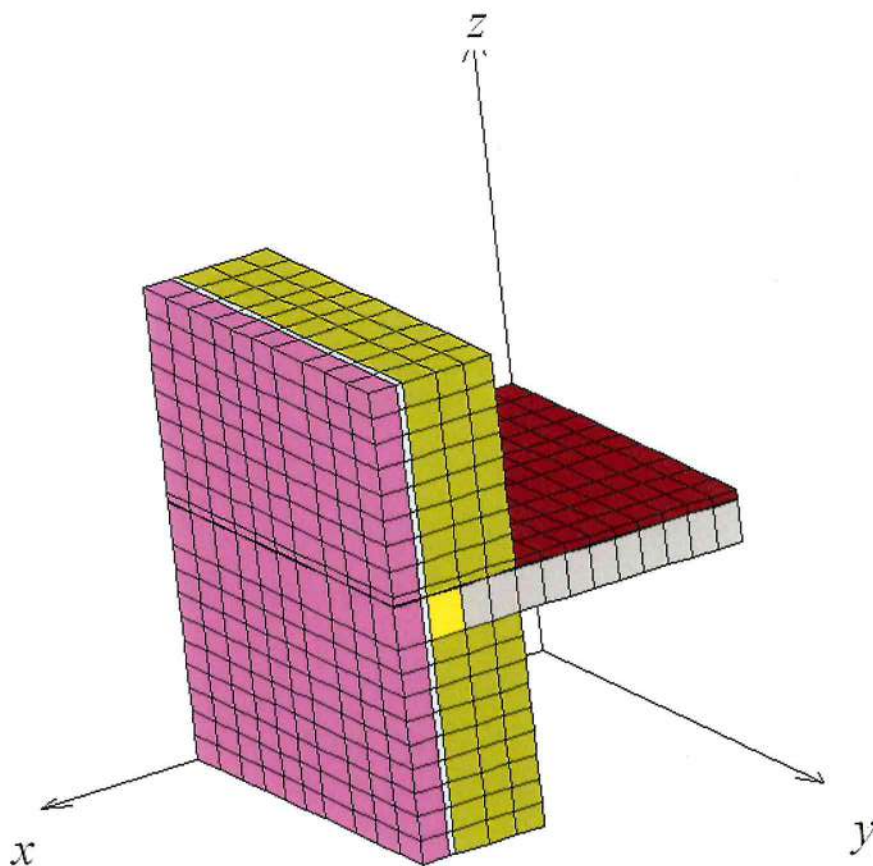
Расчетный участок плиты перекрытия с облицовкой кирпичом.
